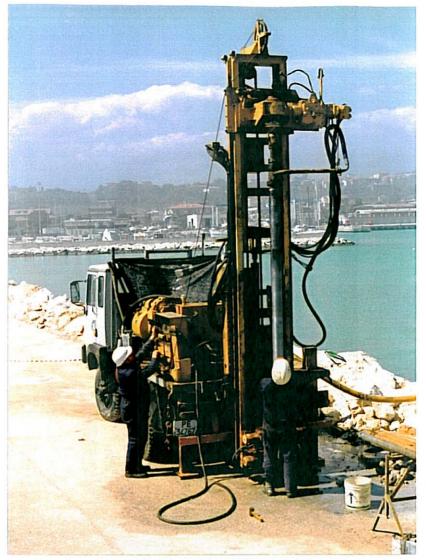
Piazzola d' indagine n° 5 – S5 : sondaggio a rotazione e carotaggio continuo
